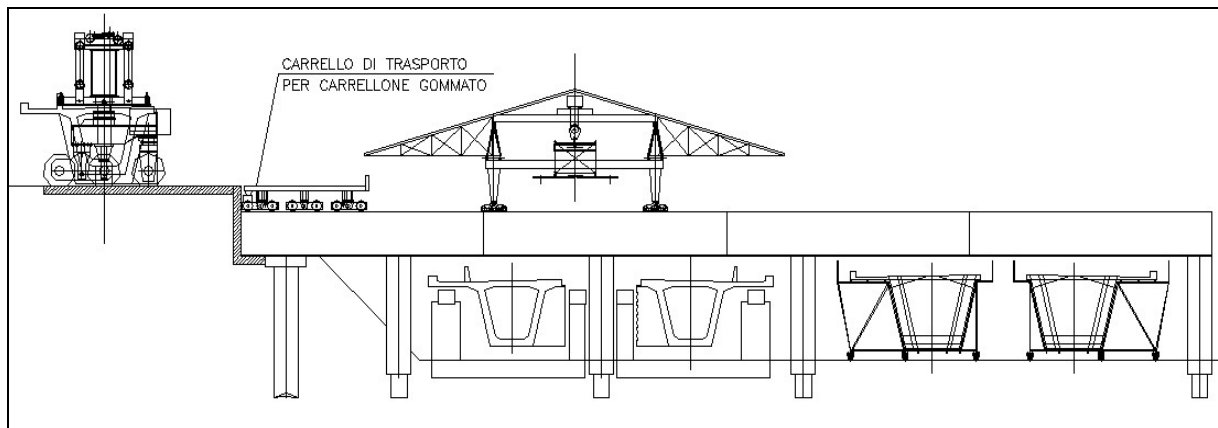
SEZIONE TRASVERSALE DELL'IMPIANTO.
